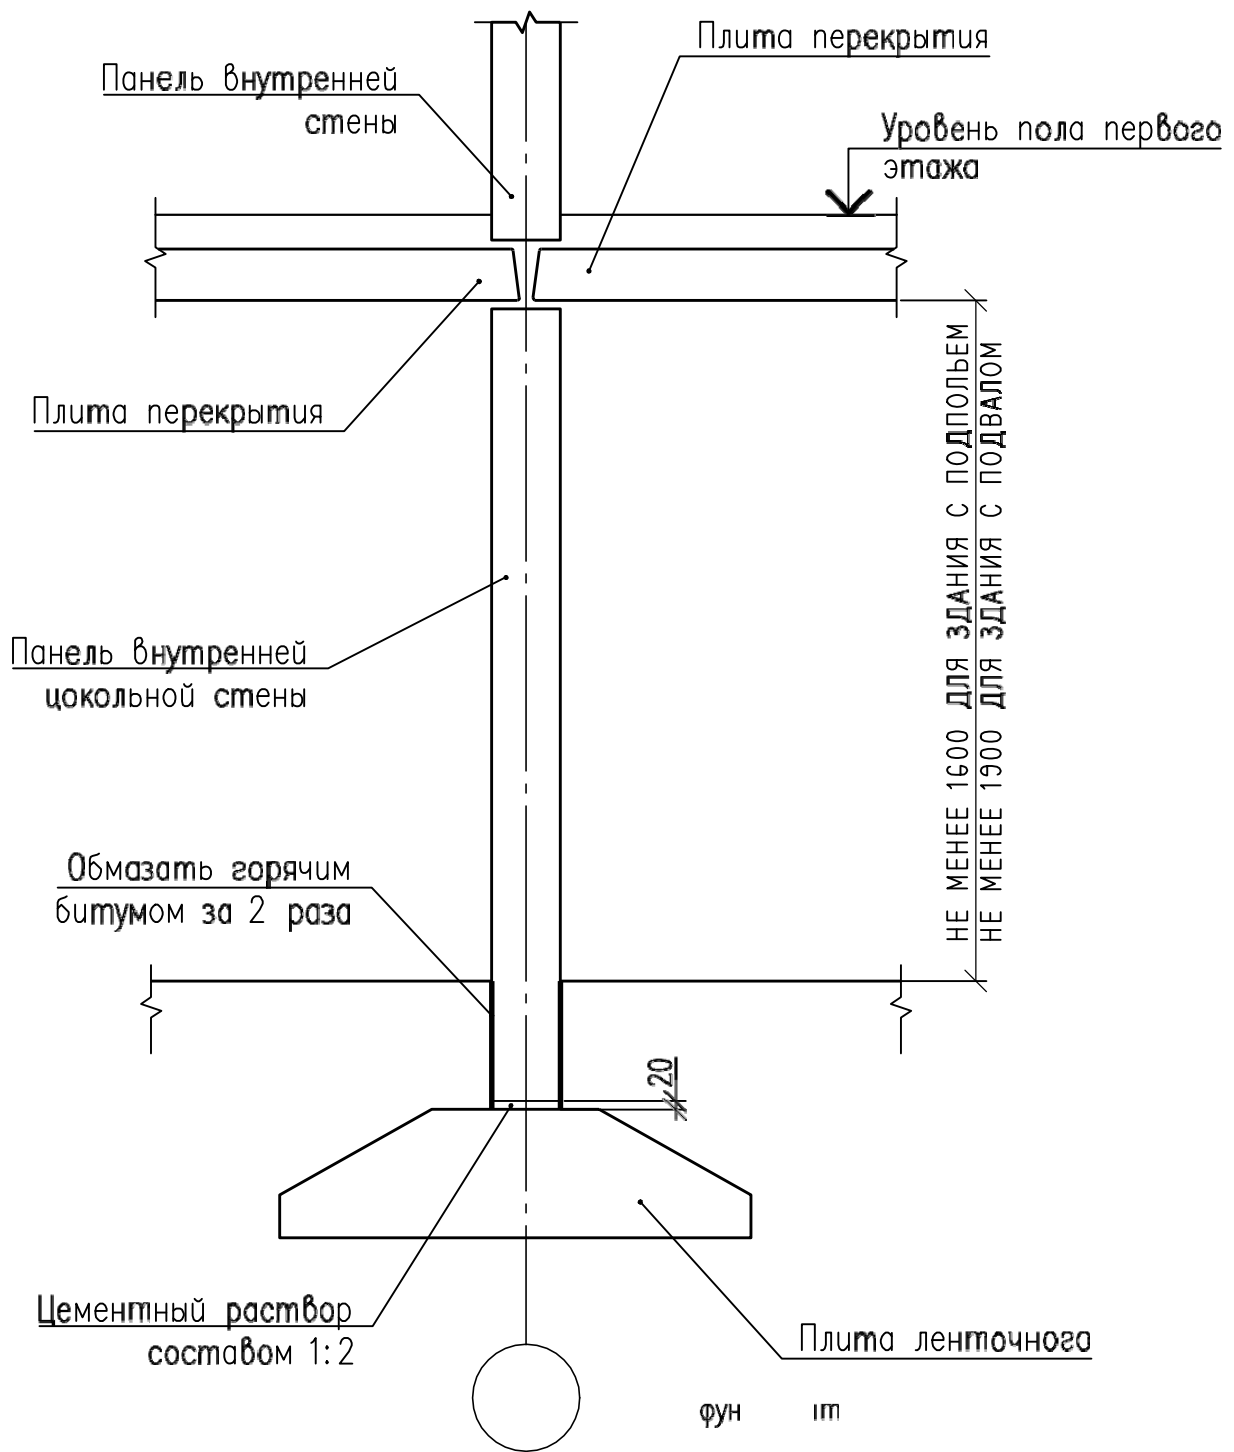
Сборный железобетонный ленточный фундамент под несущую внутреннюю стену
